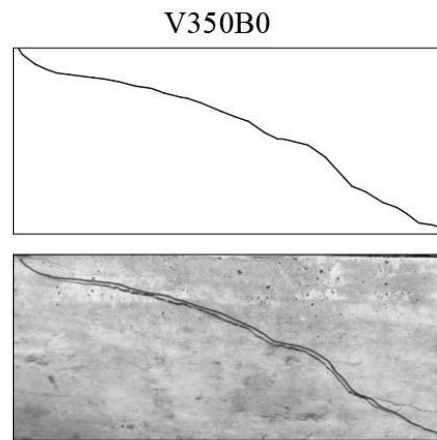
Padrão de fissuração da viga V350B0.
